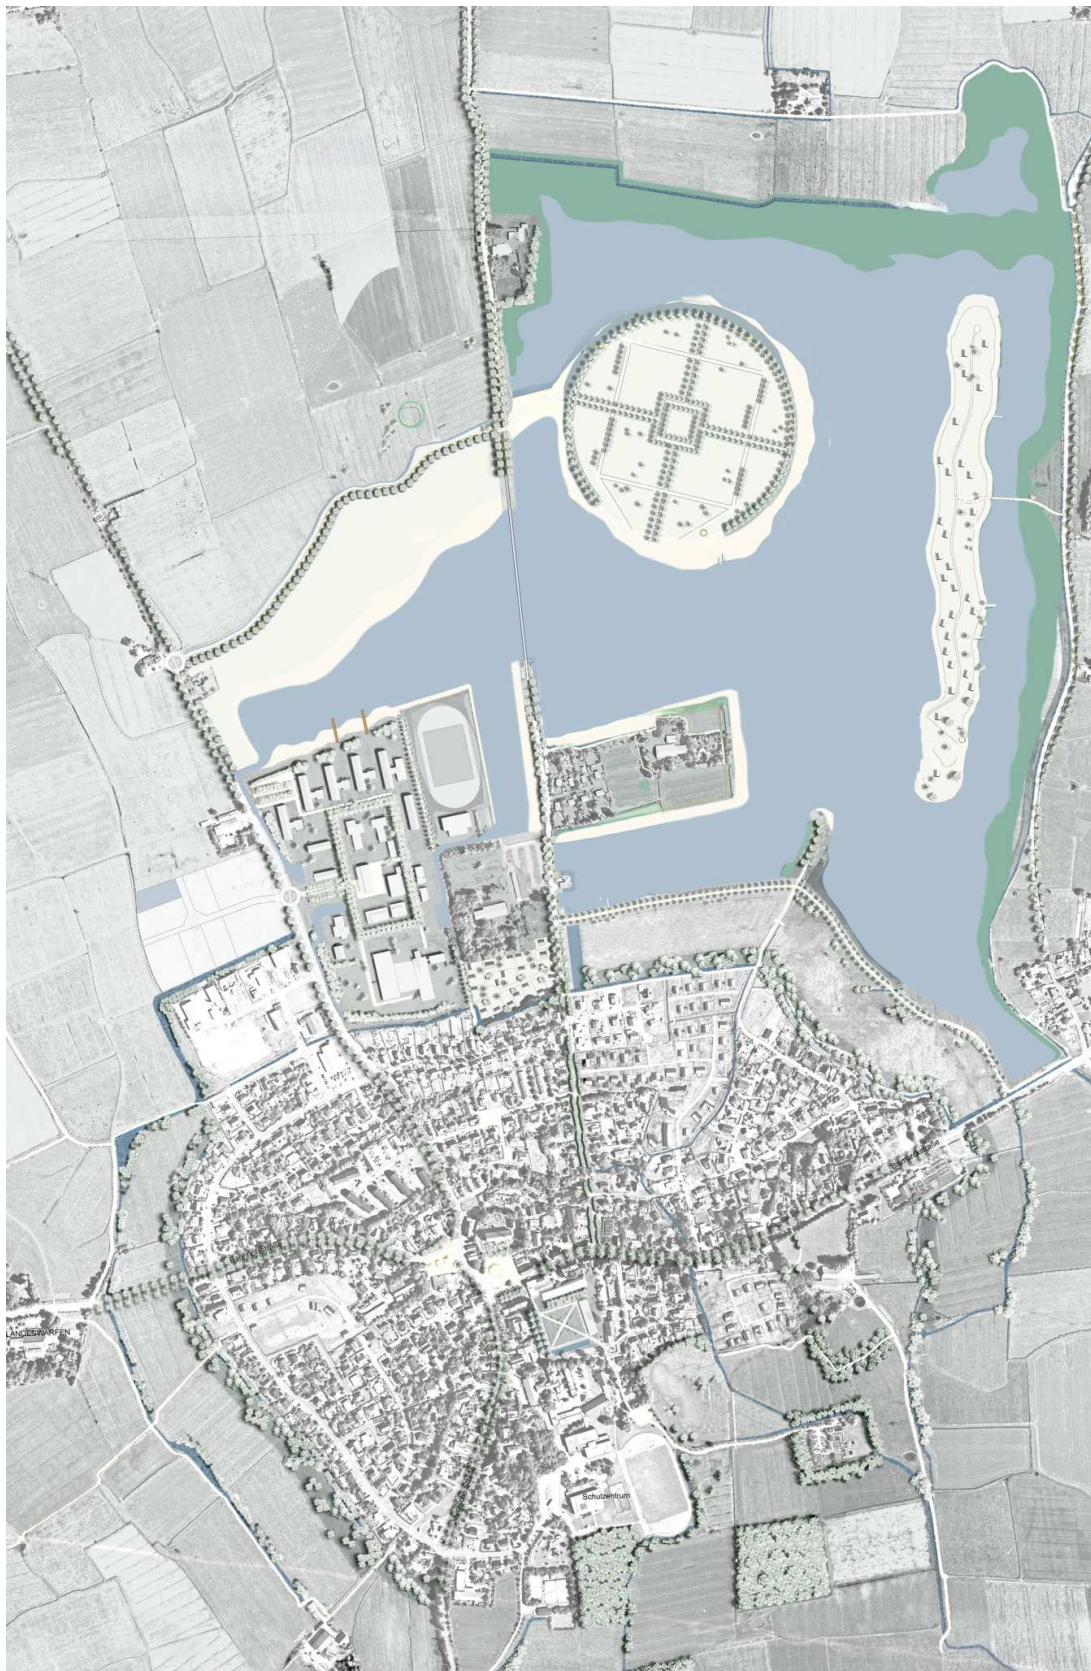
Planskizze Wangermeer und Ortssanierung Hohenkirchen (Ausschnitt;
